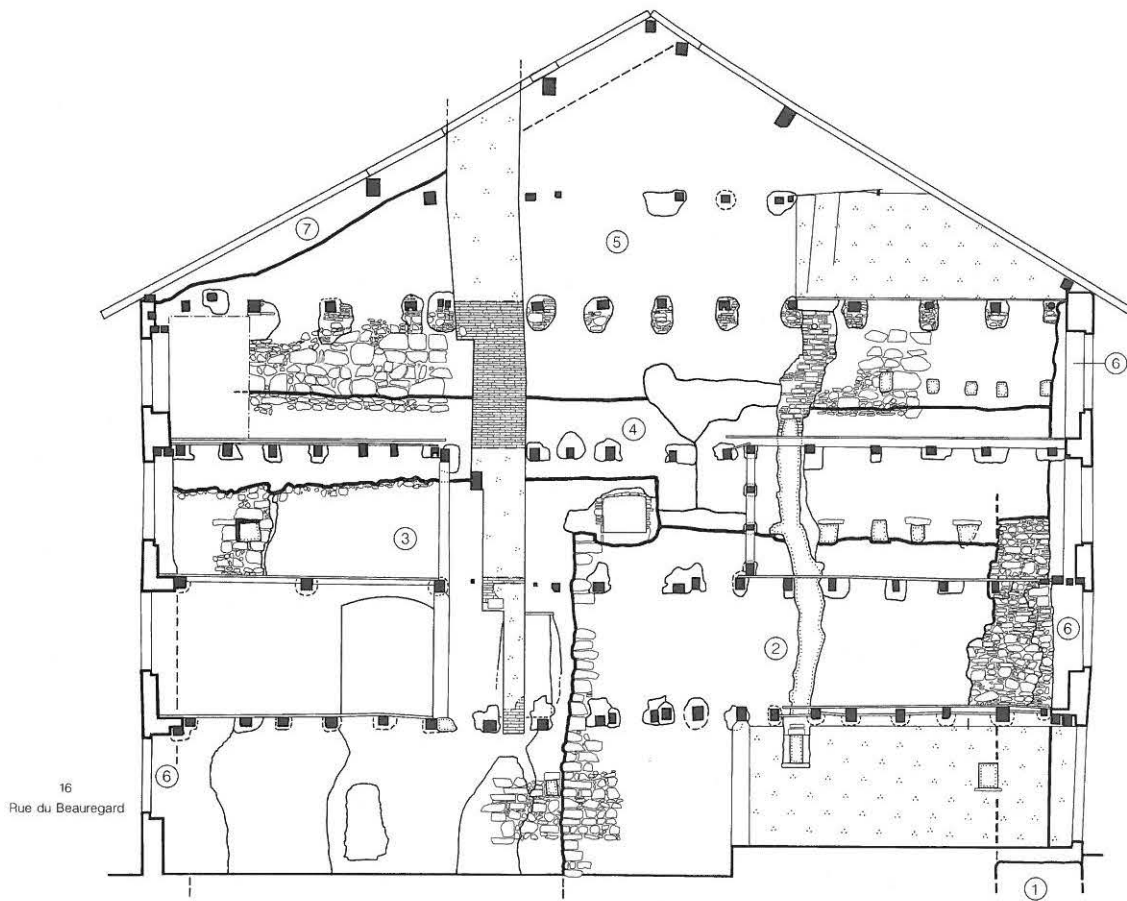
La Neuveville, Rue du Beauregard 16. Vestiges du mur coupe-feu sud. Echelle 1:150. 1 Mur d'enceinte, 2 Noyau sud, 3 Agrandissement côté rue, 4 Réhaussement, 5 Pignon, 6 Façades, 7 Correction de la toiture.
